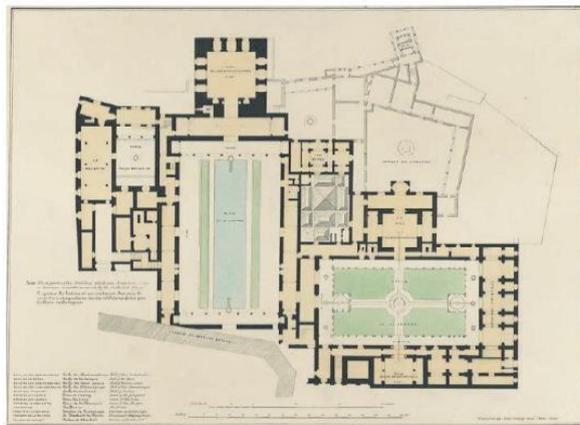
O. Jones y J. Goury. Planta de la Casa Real Vieja de la Alhambra (Fuente: *Plans, Elevations and Sections of the Alhambra*, 1842-45)
